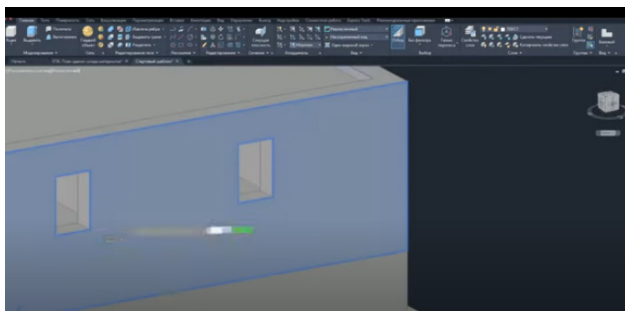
Побудована 3-D конструкція будівлі із заповненими стінами та вікнами
